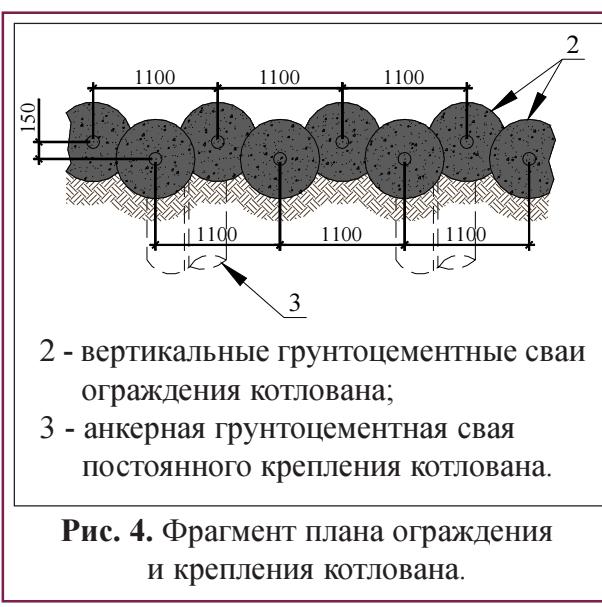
Фрагмент плана ограждения и крепления котлована.
